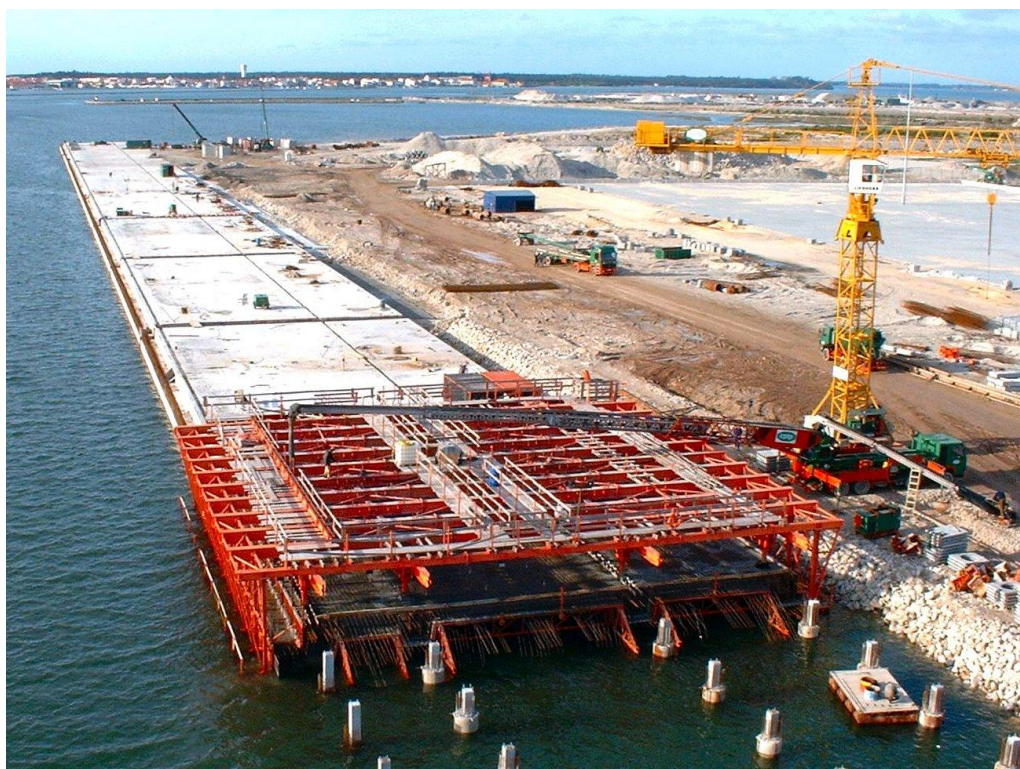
Vista geral dos trabalhos (06-03-2003)
